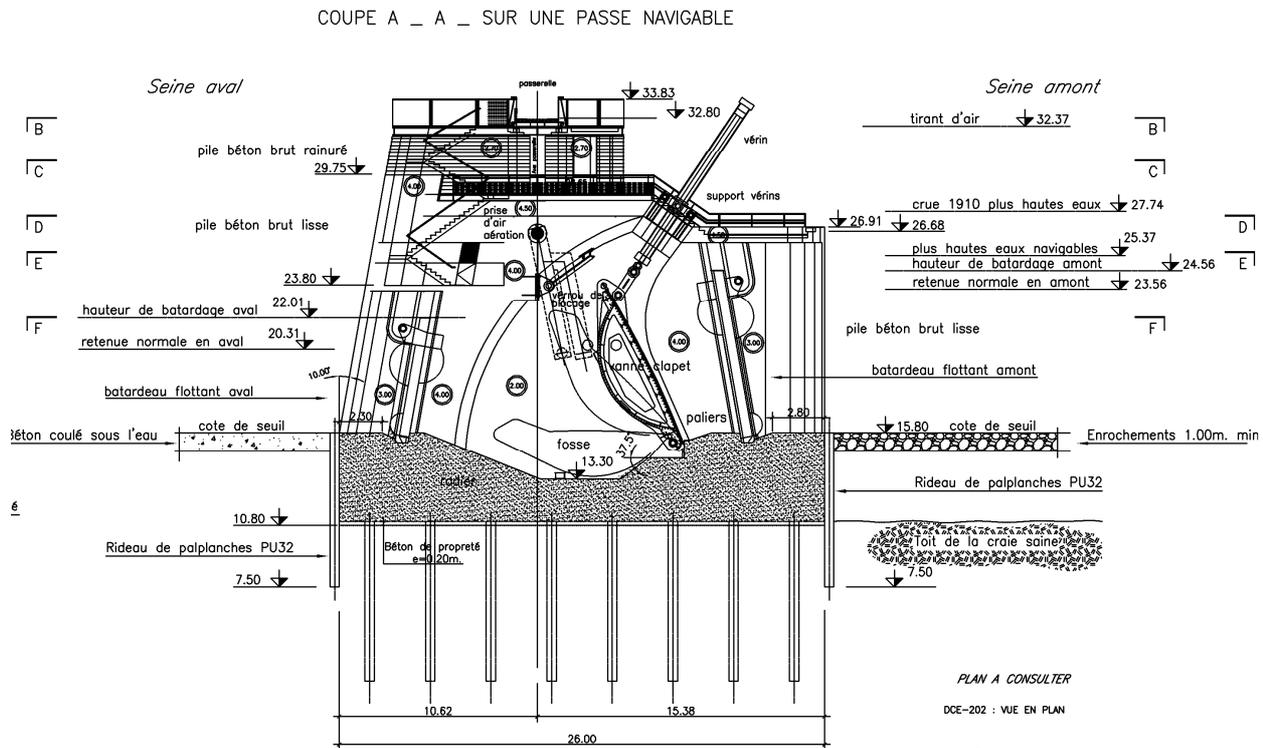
Coupe en travers d'une passe navigable du nouveau barrage de Chatou (cote NGF - IGN69)
